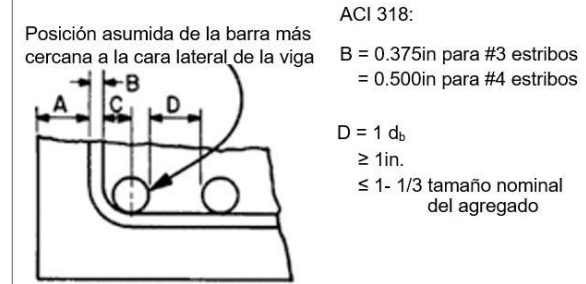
Dado que este tipo de herramientas de diseño no contempla las tolerancias de construcción ni los requisitos para la colocación y consolidación adecuadas del concreto, pueden provocar problemas de panalización en vigas y trabes (de la Tabla A-3 en la Referencia ...)
